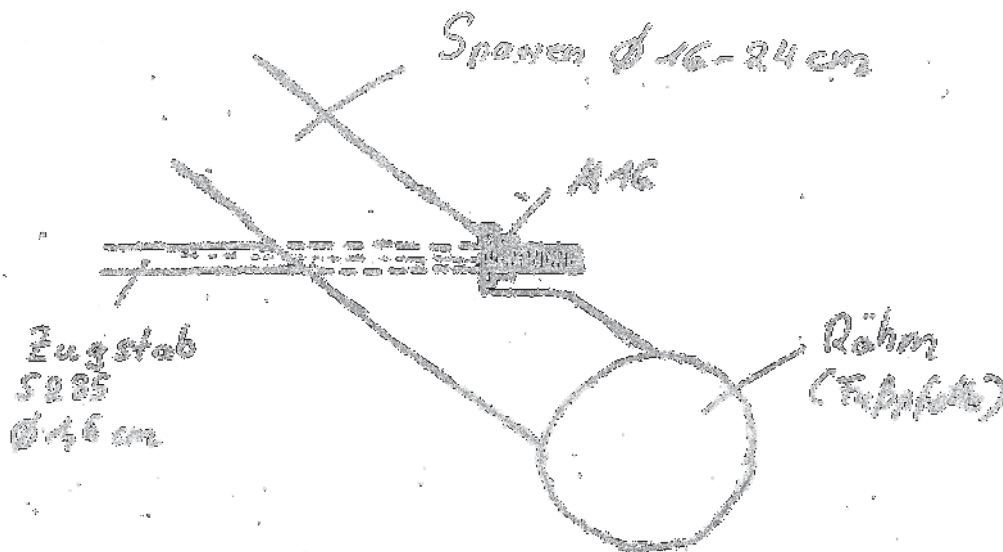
Detailanschluss: Zugstab an Sparren Variante 2
